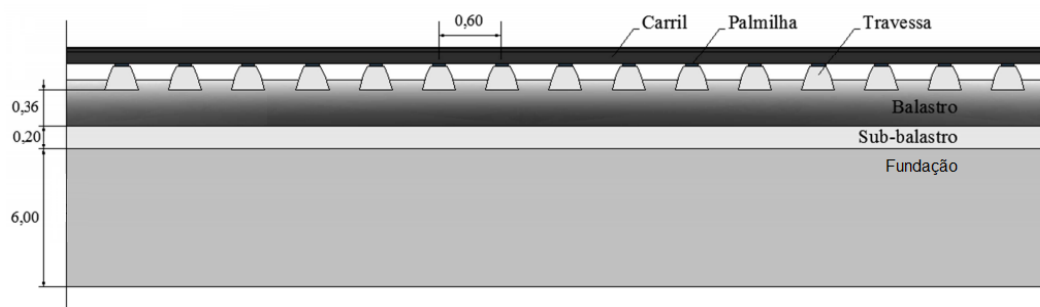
Representação esquemática do perfil longitudinal da via (adaptado de Alves Ribeiro 2012)
